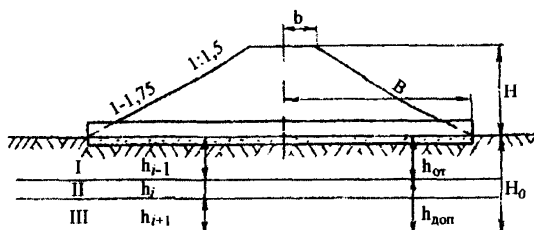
Схема к расчету осадок труб на оттаивающих грунтах
